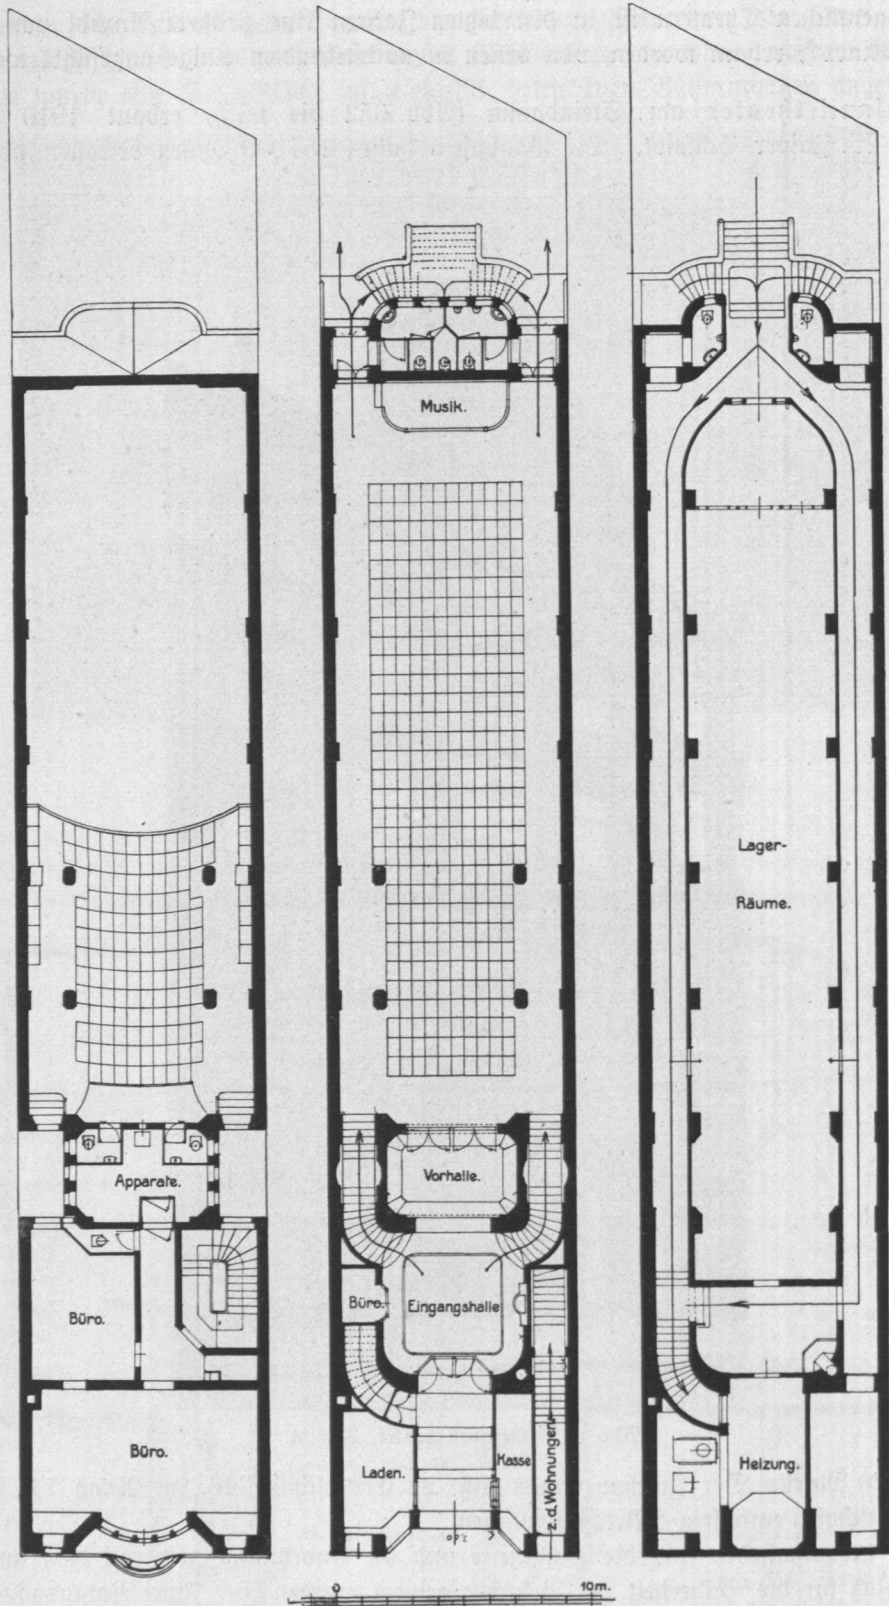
bis 655. Atlantichtheater, Grundrisse des Ober-, Erd- und Kellergeschosses.
